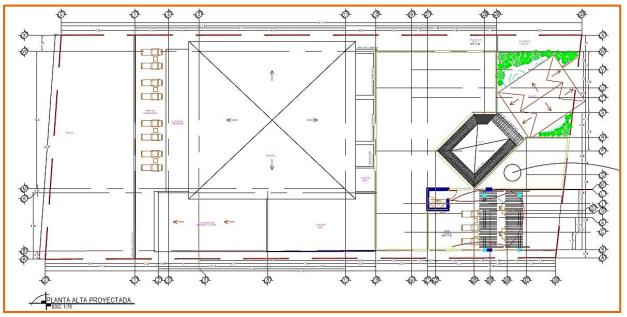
Plano arquitectónico del nivel Azotea del proyecto.
